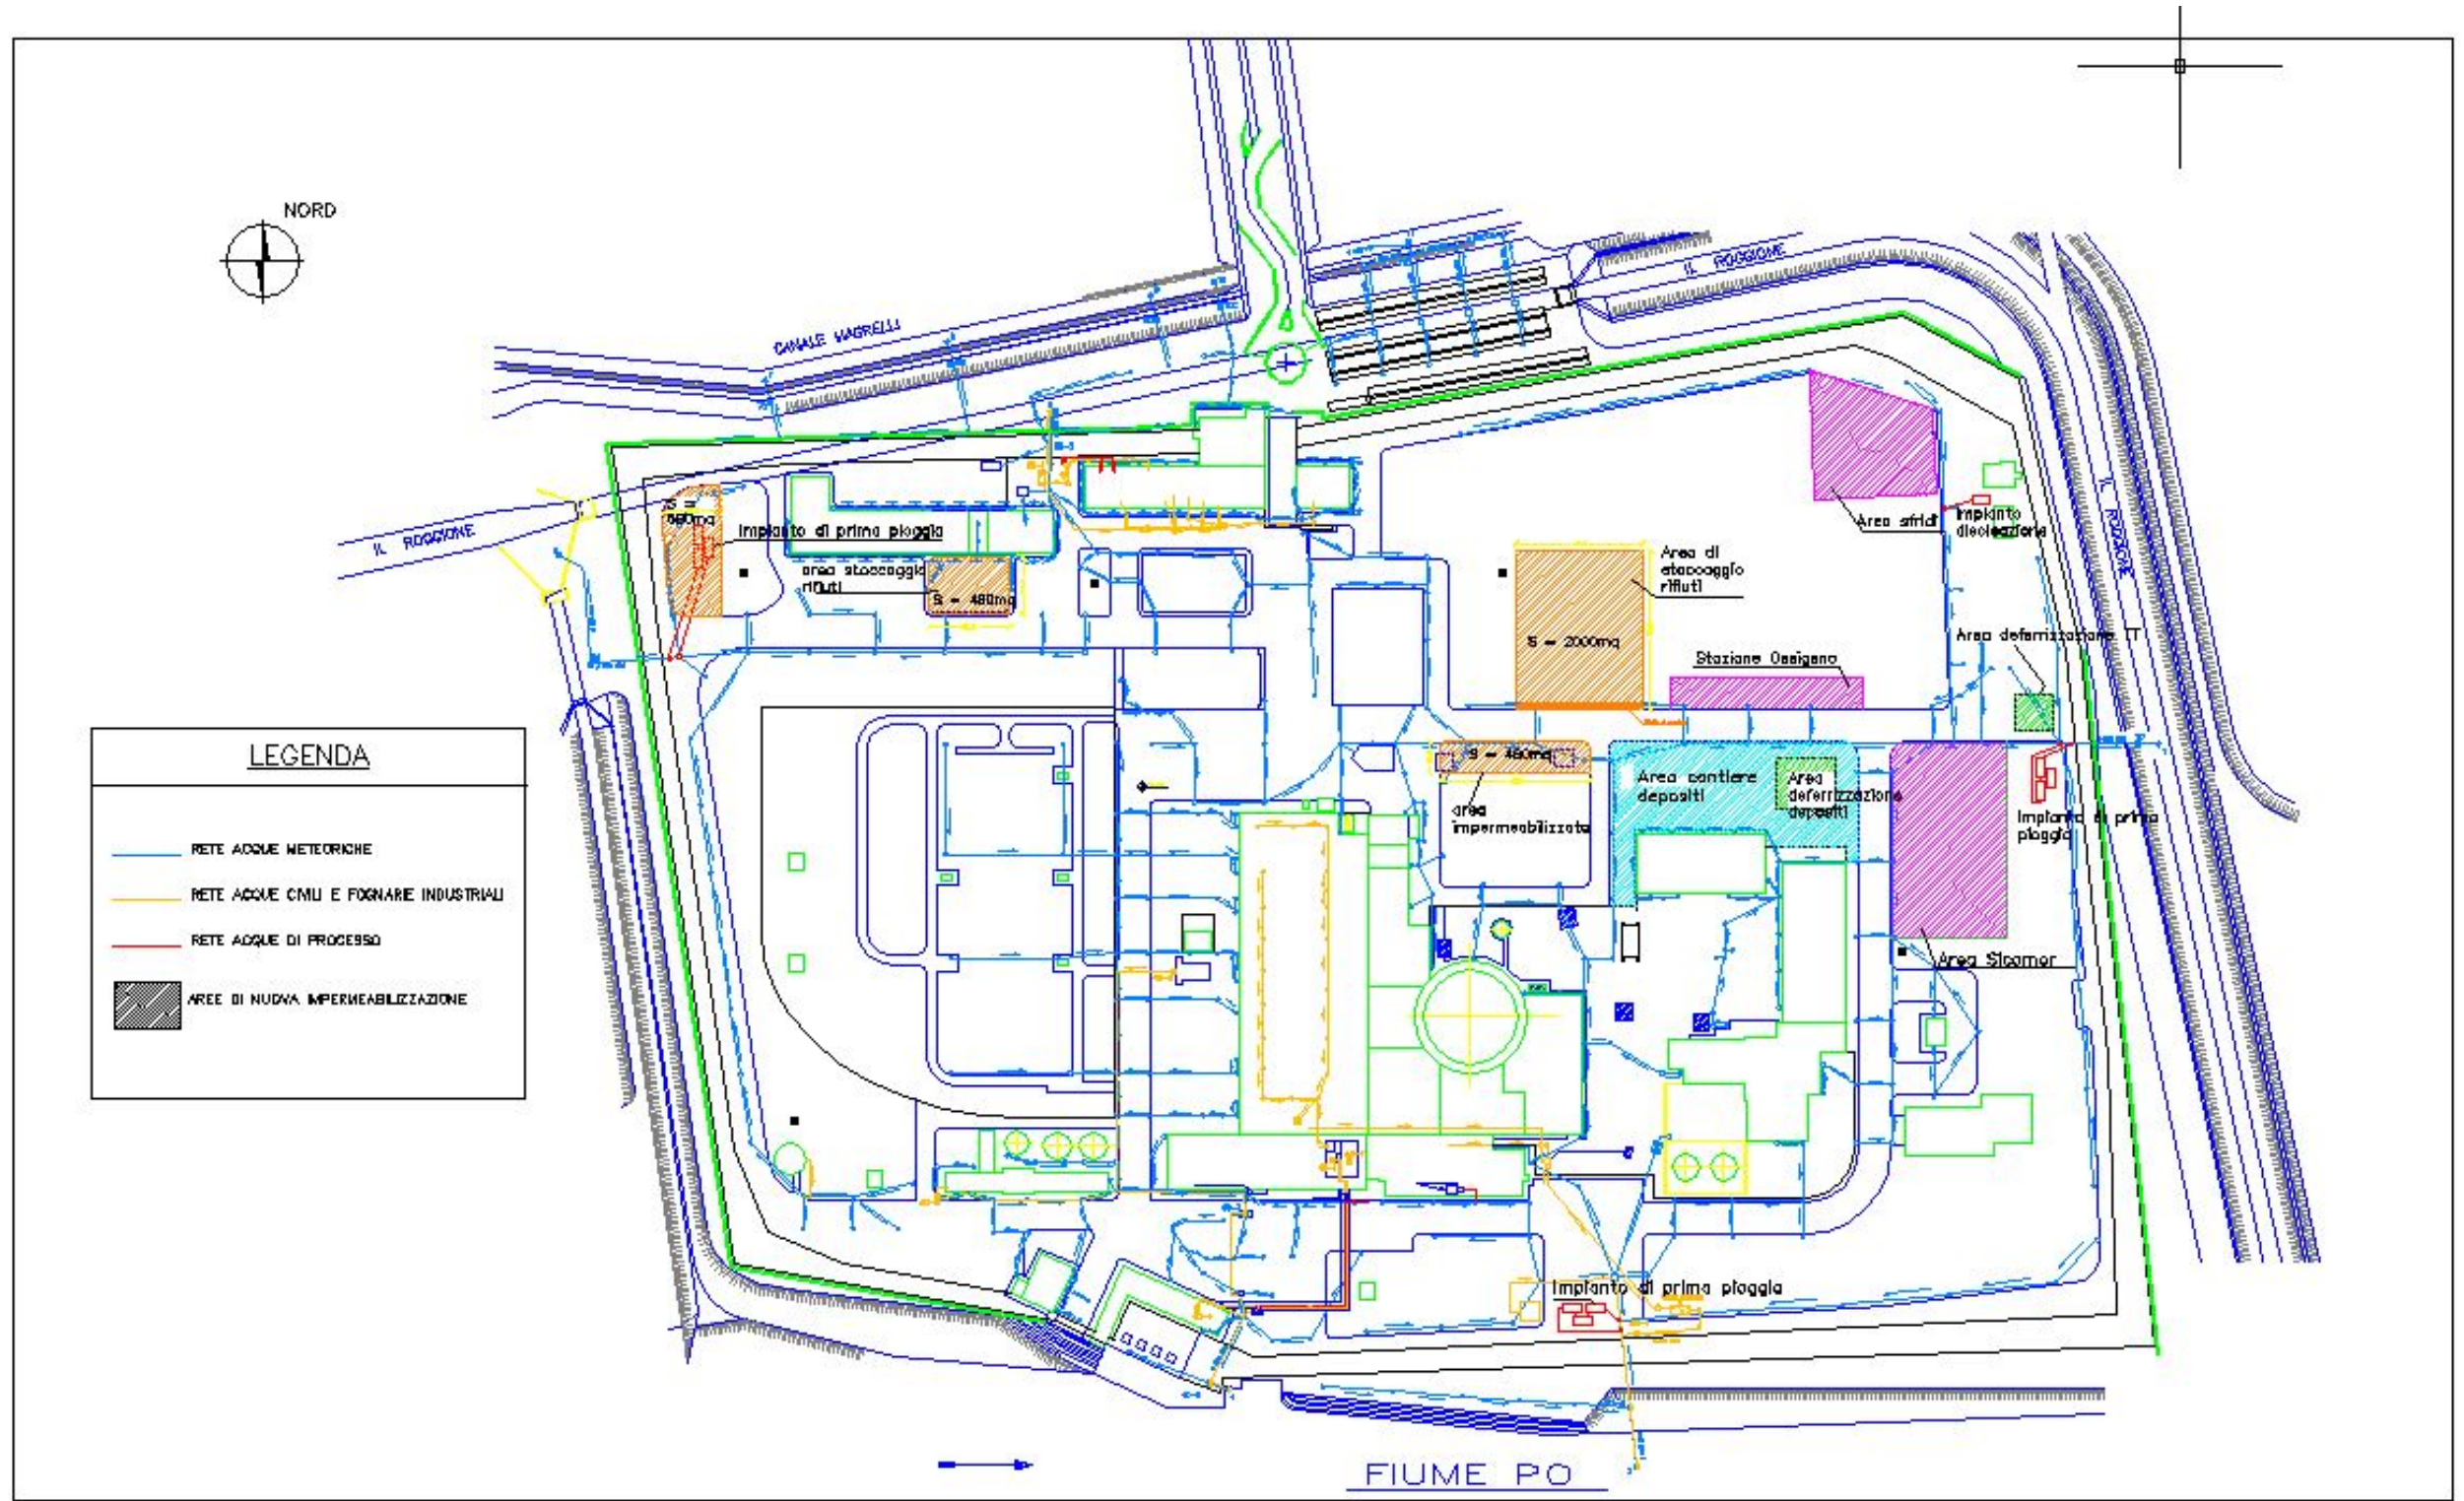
/1 - Planimetria dell'impianto con ubicazione delle aree di nuova impermeabilizzazione (evidenziate con campitura) e delle reti di drenaggio delle acque meteoriche e vasche di prima pioggia
